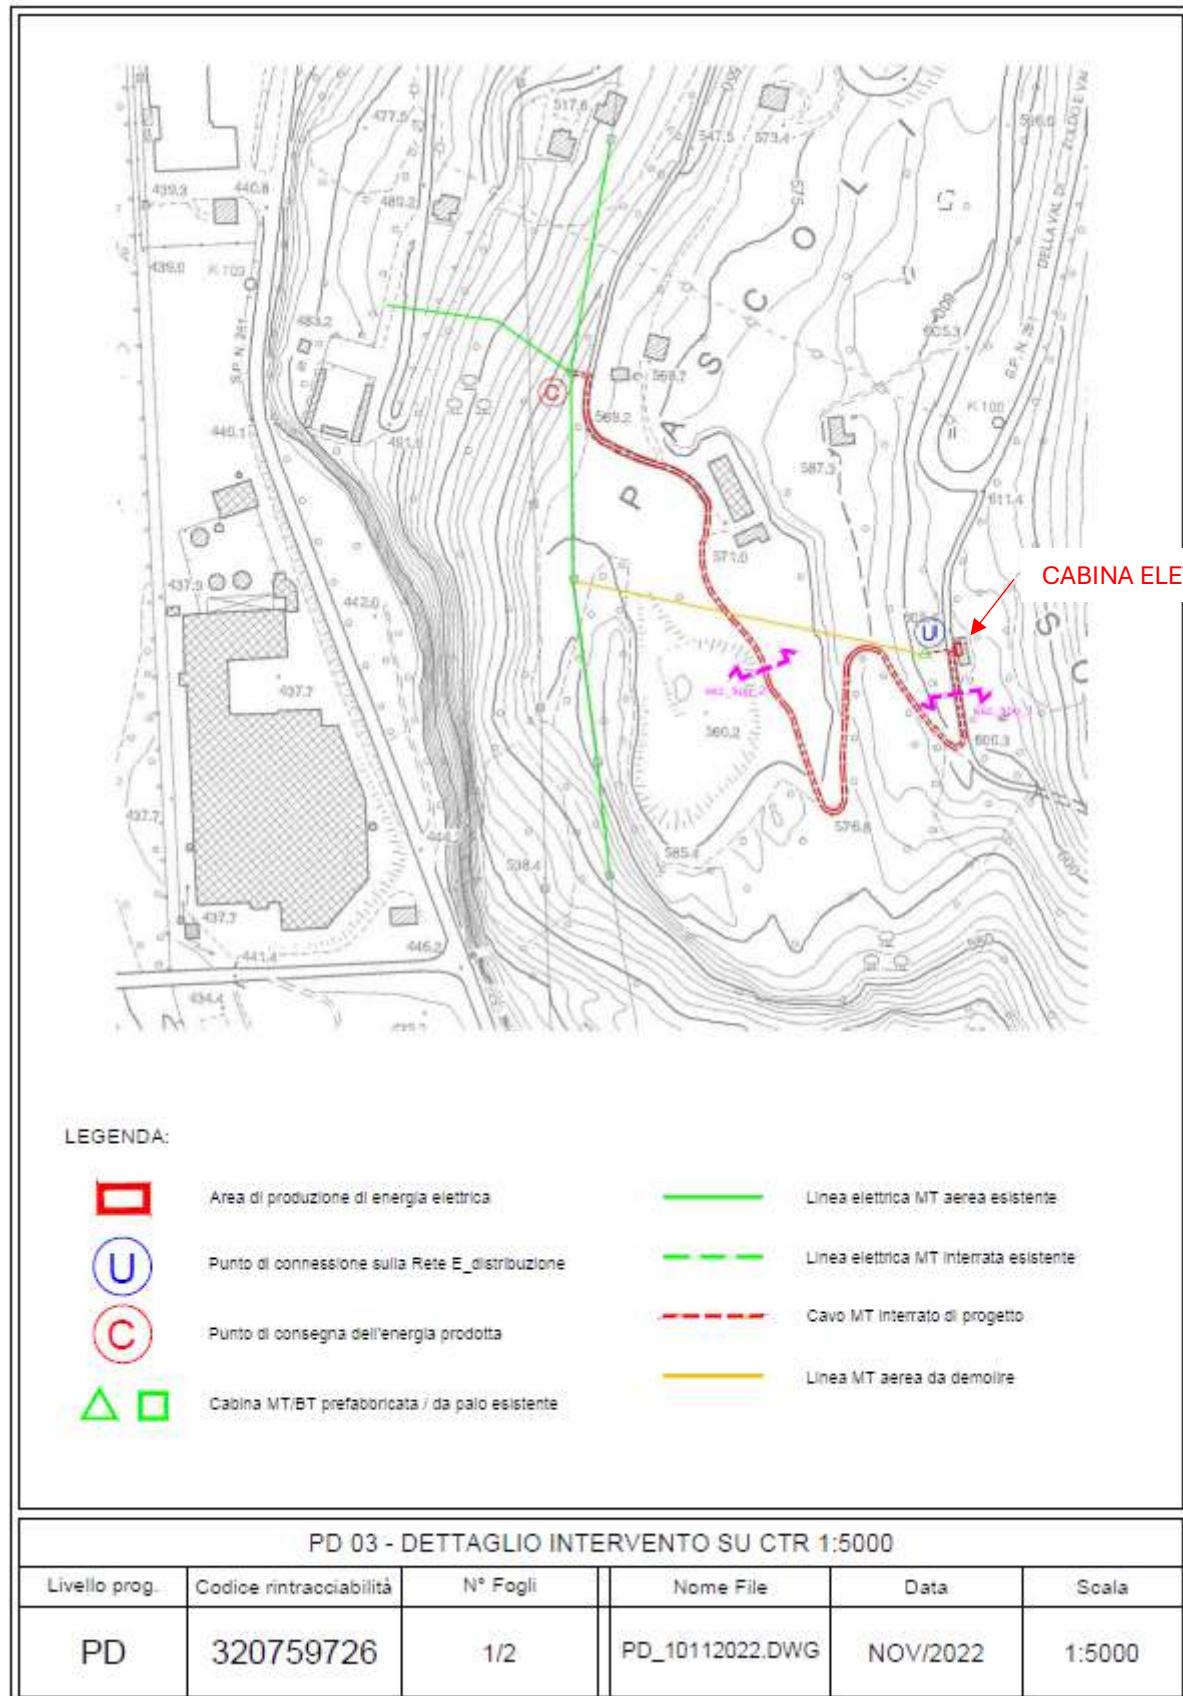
Estratto dal Progetto definitivo dell'impianto di rete - Individuazione dei nuovi tracciati interrati a nord di Longarone (località Castellavazzo) e posizione della cabina elettrica
